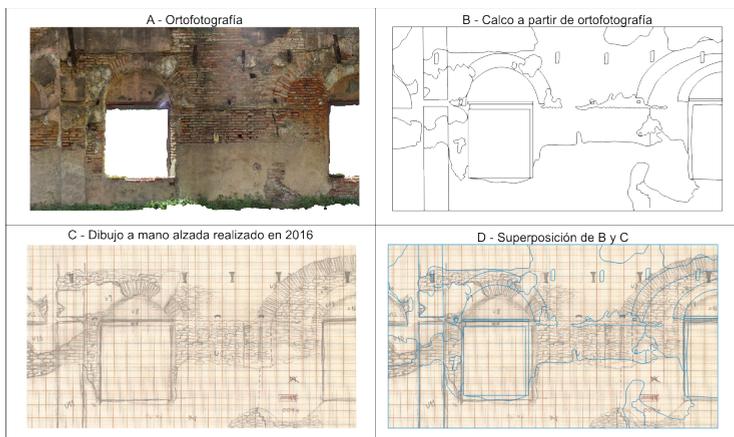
Área de muestra de sectores del muro y UEM inaccesibles en el campo.
